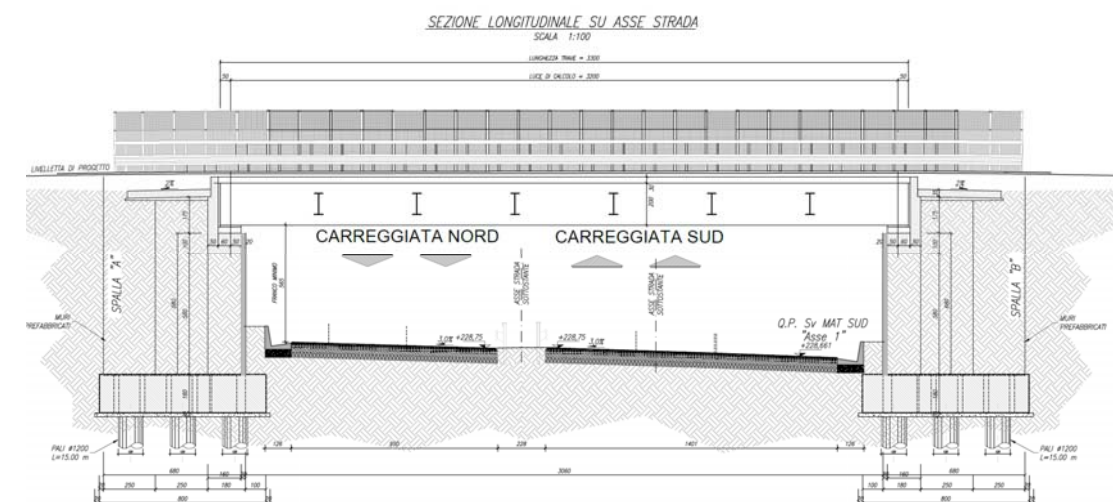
Cavalcavia Svincolo Matera Sud: Sezione Longitudinale
